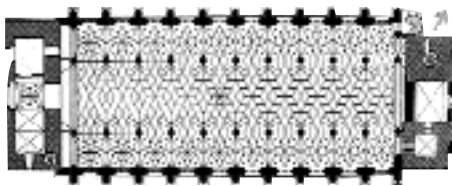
Halle, Grundriß der Marktkirche über den Emporen
